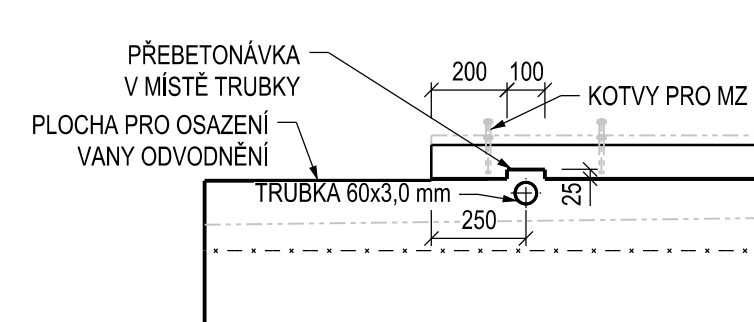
PRŮCHOD SĎĚLOVACÍCH KABELŮ PŘES MZ, 1:5
